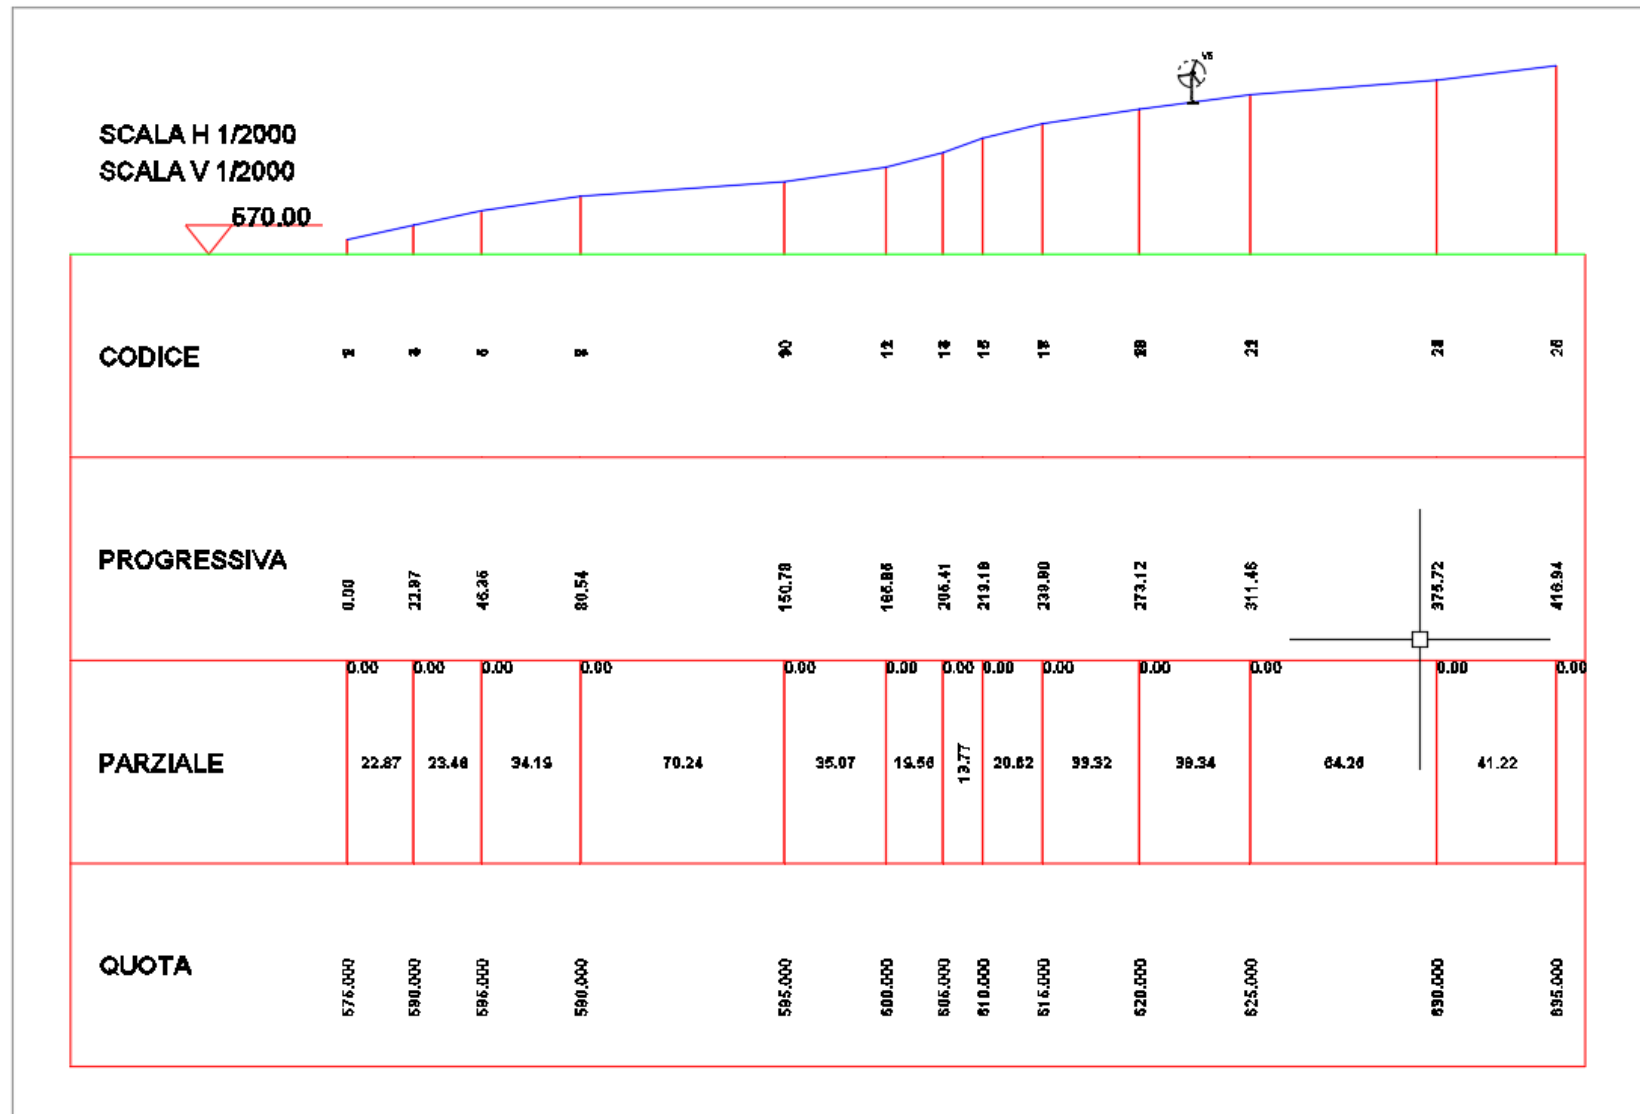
Profilo Sezione B-B' e ubicazione generatore di progetto V5
